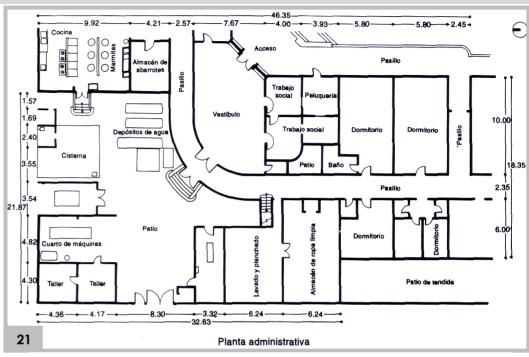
Planta alta general del proyecto "Casa para ancianos Arturo Mundet" IMAGEN 21 Planta Administrativa. Ídem.
